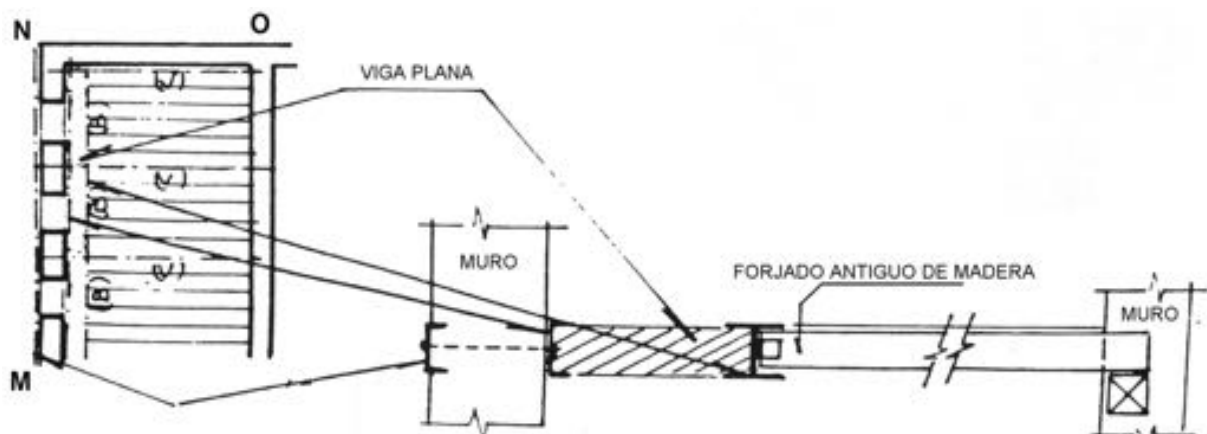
SOLUCION PARA REFUERZO DE FORJADO QUE EVITE EL PANDEO
